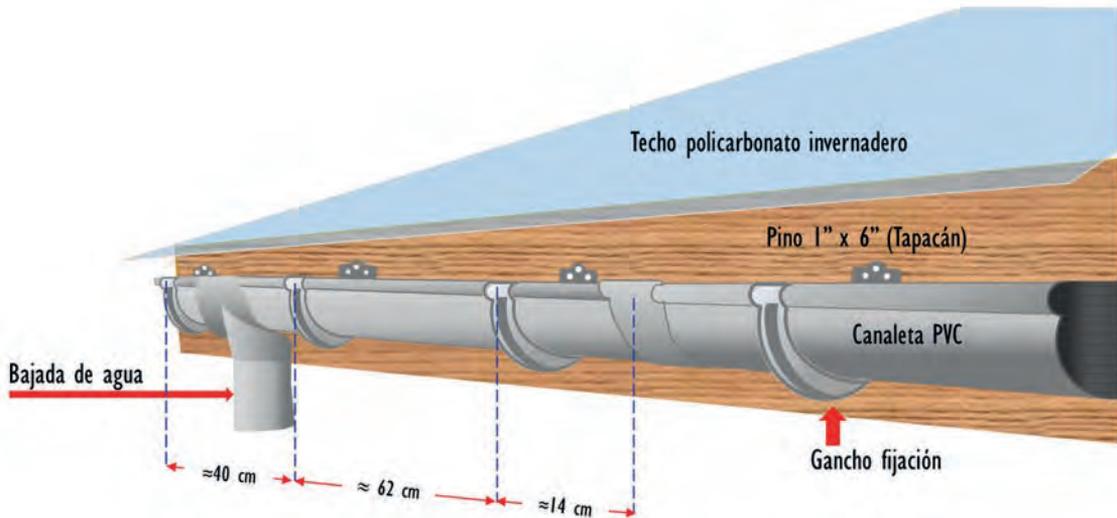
Esquema para una instalación básica de canaletas en un techo. (Fuente: Elaboración propia).
